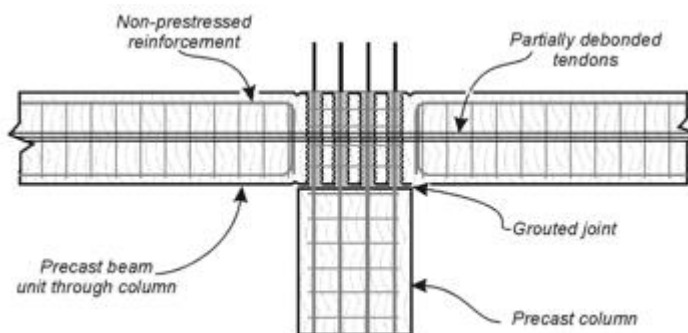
Vigas prefabricadas mecedoras (Blandón & Rave, 2016).
